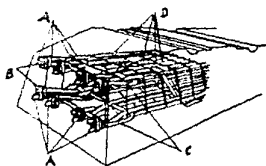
DETALLE DEL ARMADO DEL DURMIENTE V.W.
